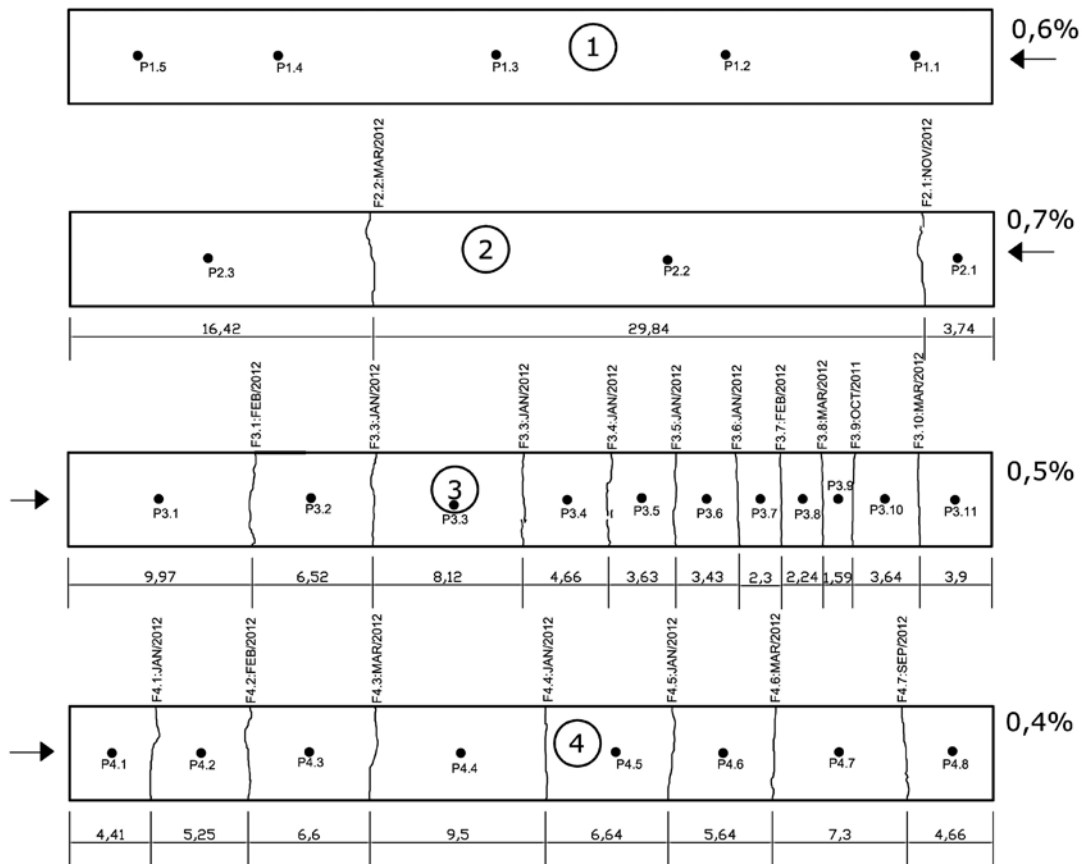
Mapa de fissuras (atualizado: junho de 2014)
